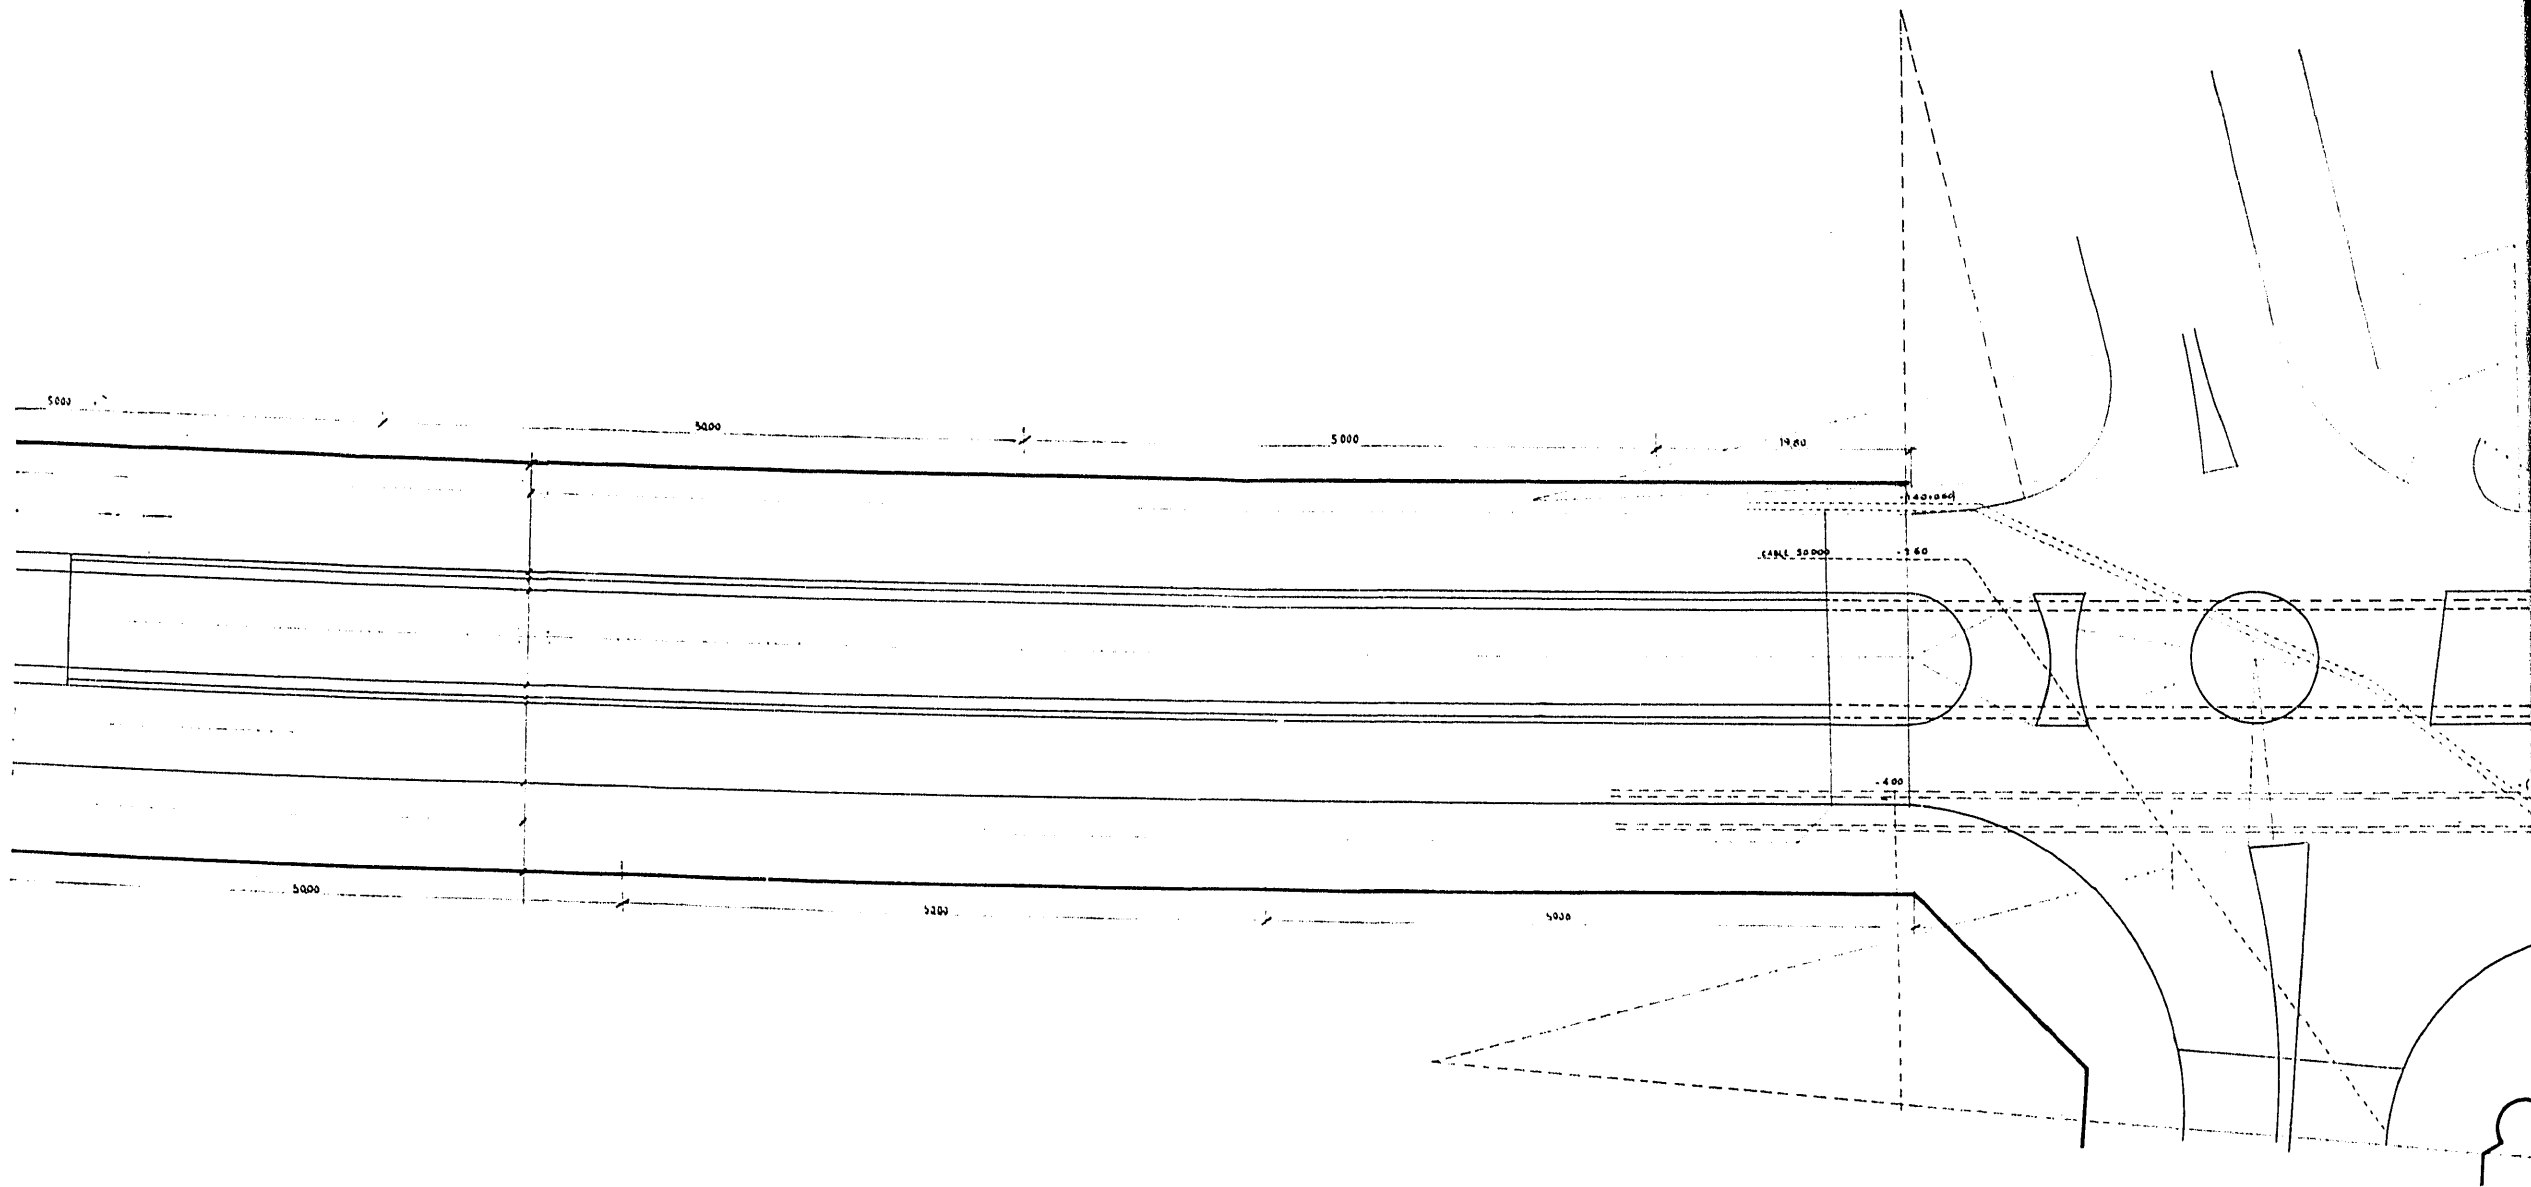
Planta del paso subterráneo en la calle Alfonso XII.
